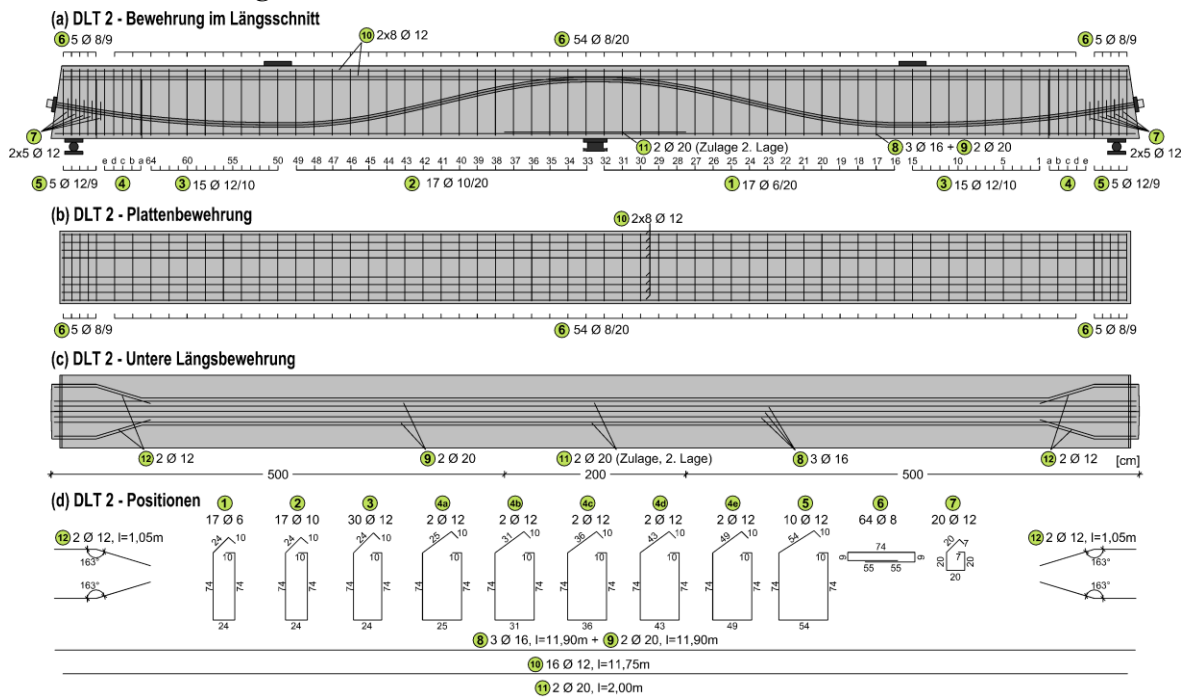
Bewehrungsplan Versuchsträger DLT 2
